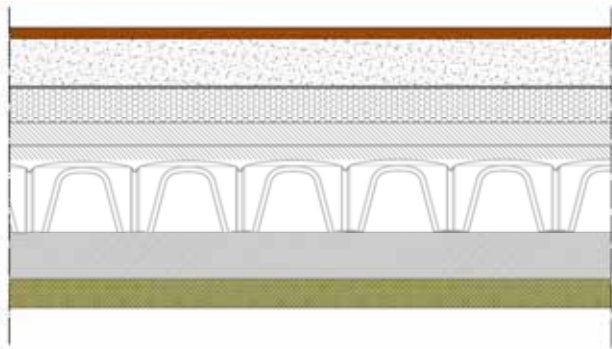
solaio con vespaio areato, strato isolante, massetto per il passaggio degli impianti e nuova pavimentazione
